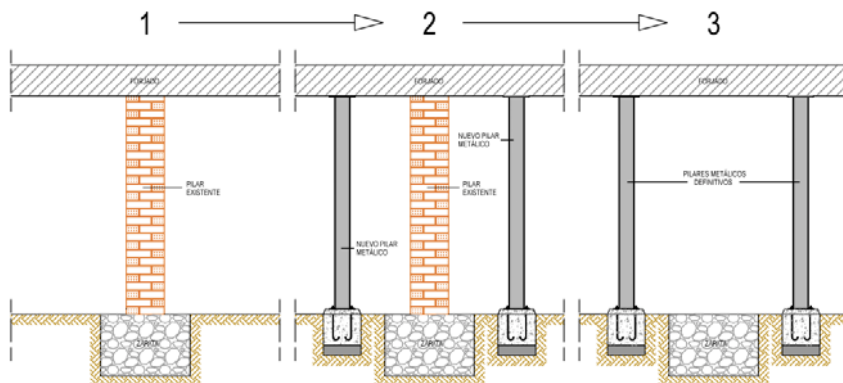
Sustitución integral de pilar. Fuente propia.
